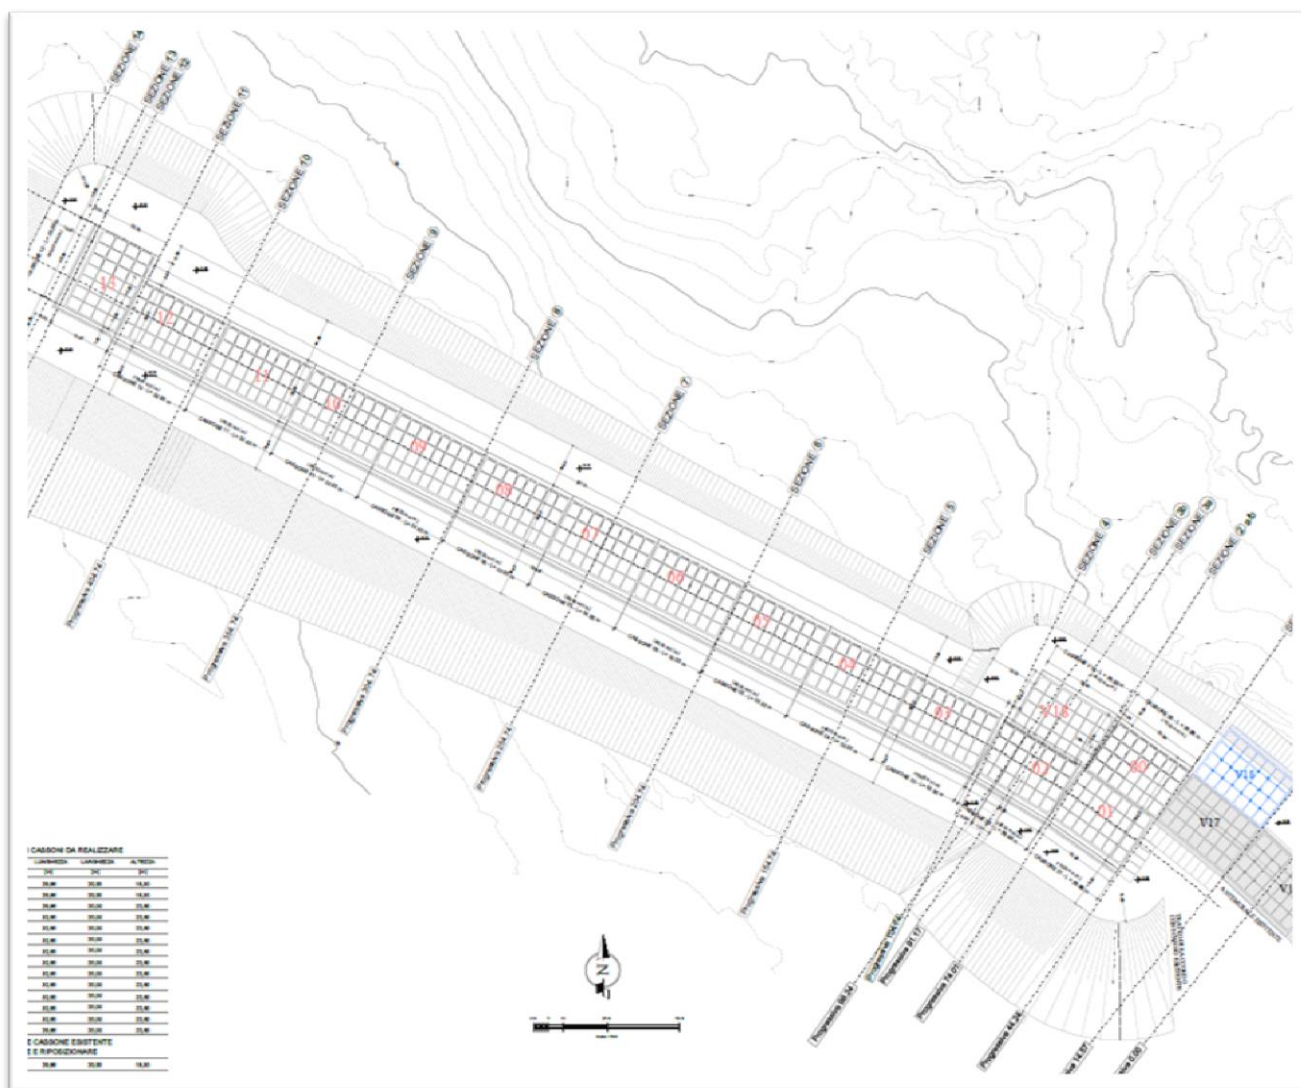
Planimetria Prolungamento Antemurale C. Colombo
